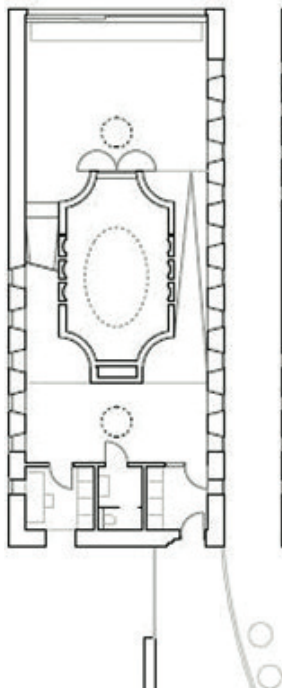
Planul oratorului de la primul etaj/ First floor plan, the oratory.
